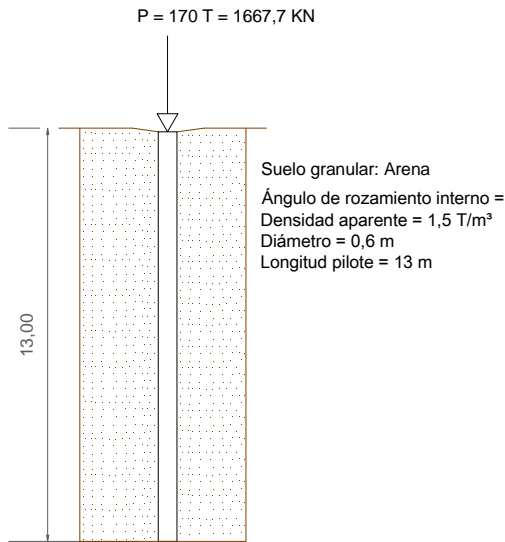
Croquis de pilote con diámetro 0,6 m y longitud pilote 13 m
